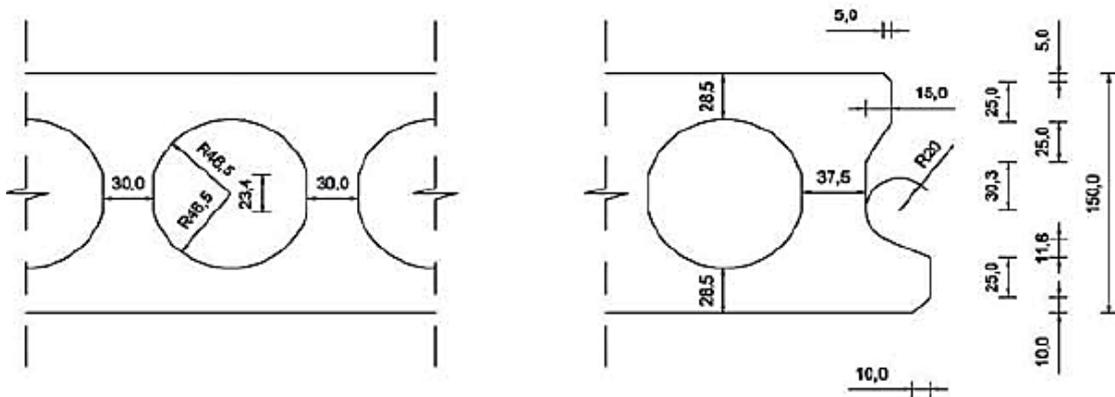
Sección acotada (en mm.) del extremo de la placa alveolar de canto 15 cm. Tomado de ficha técnica placa alveolar (15+0) ALJEMA PREFABRICADOS SL.
